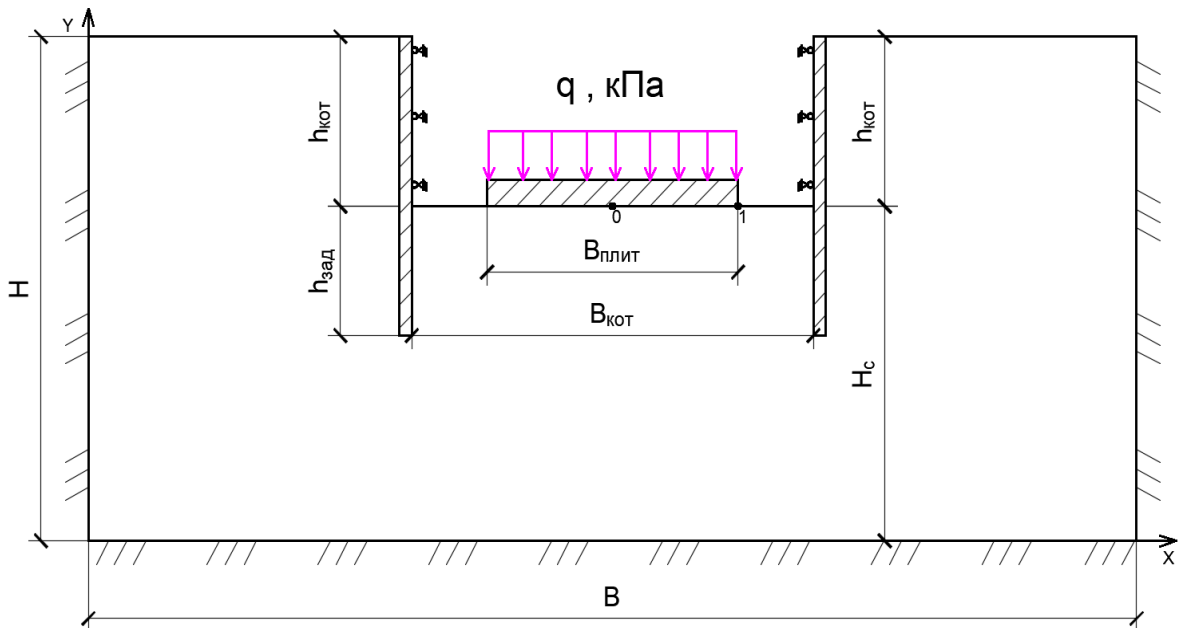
Расчетная схема для случая расположения здания в центре строительной площадки
